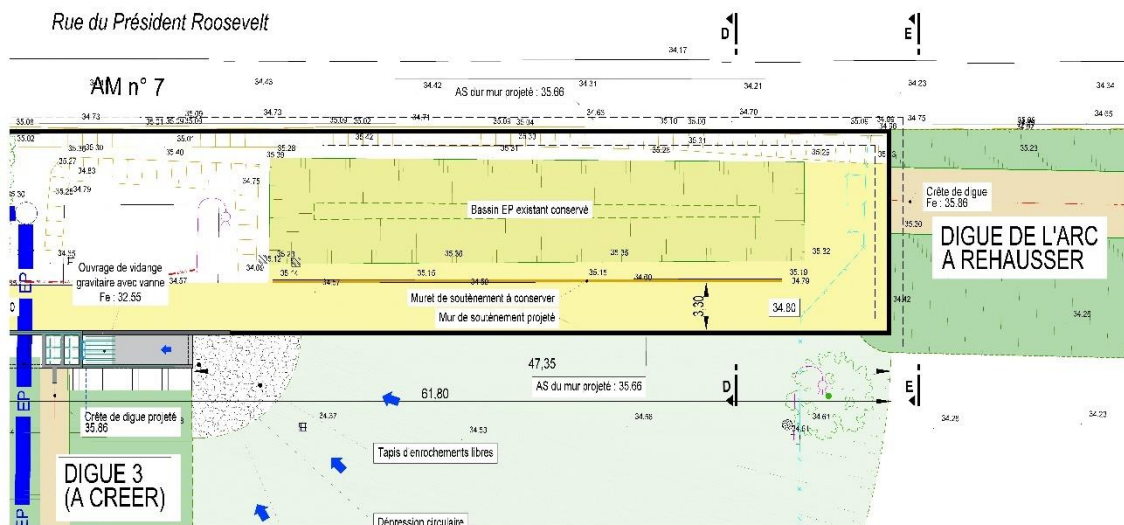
Plan et coupe de la rampe d'accès au bassin de compensation
